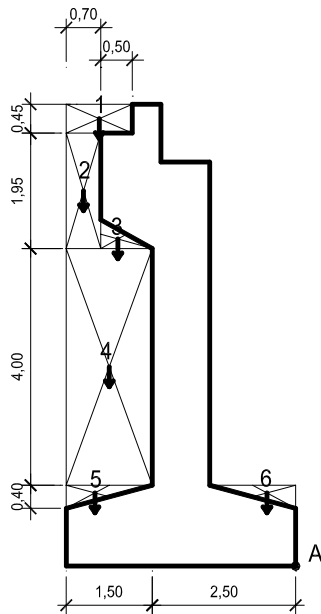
Pembebanan Akibat Berat Sendiri Abutment
